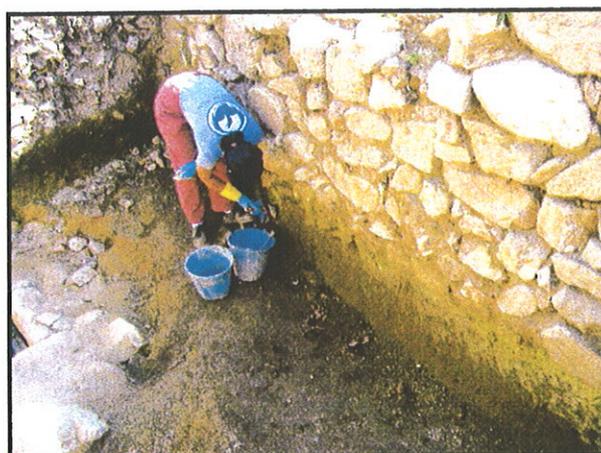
Vista de consolidación preventiva en 2005 de M24. Actualmente sustitución del perfil por una nueva cimentación.
